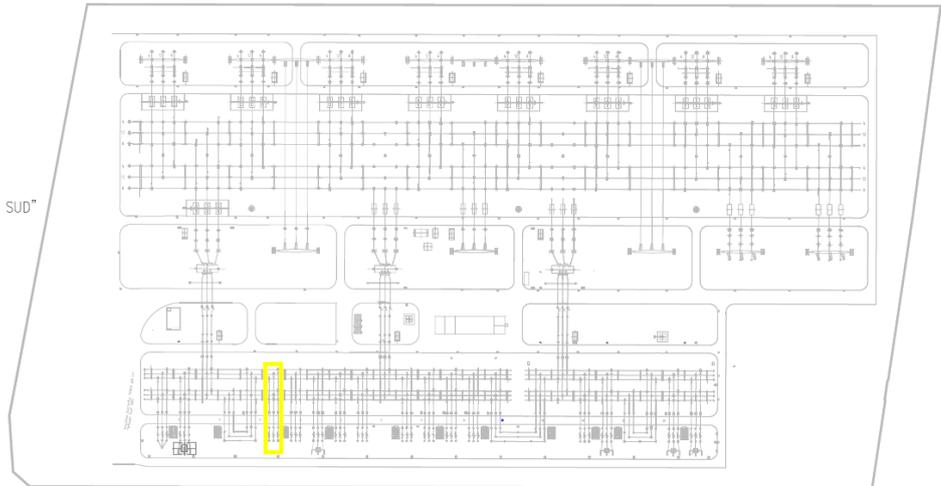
Pianta Stazione Elettrica RTN "Brindisi Sud"
